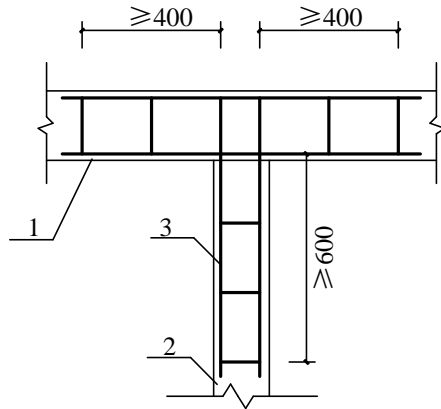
承重墙与非承重隔墙交接处的钢筋网片（单位：mm）
